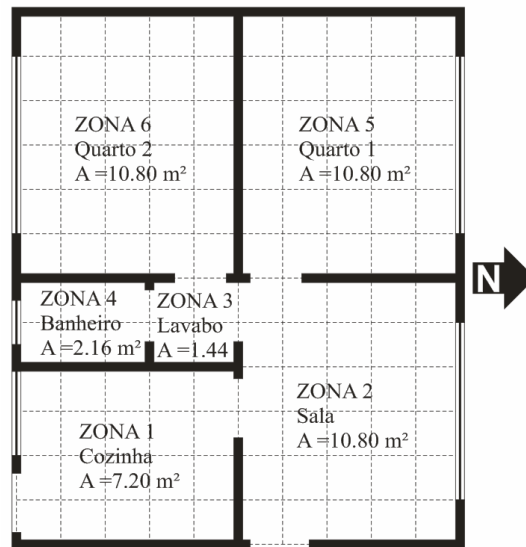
Planta baixa do modelo simulado (malha de 600 x 600 mm)
